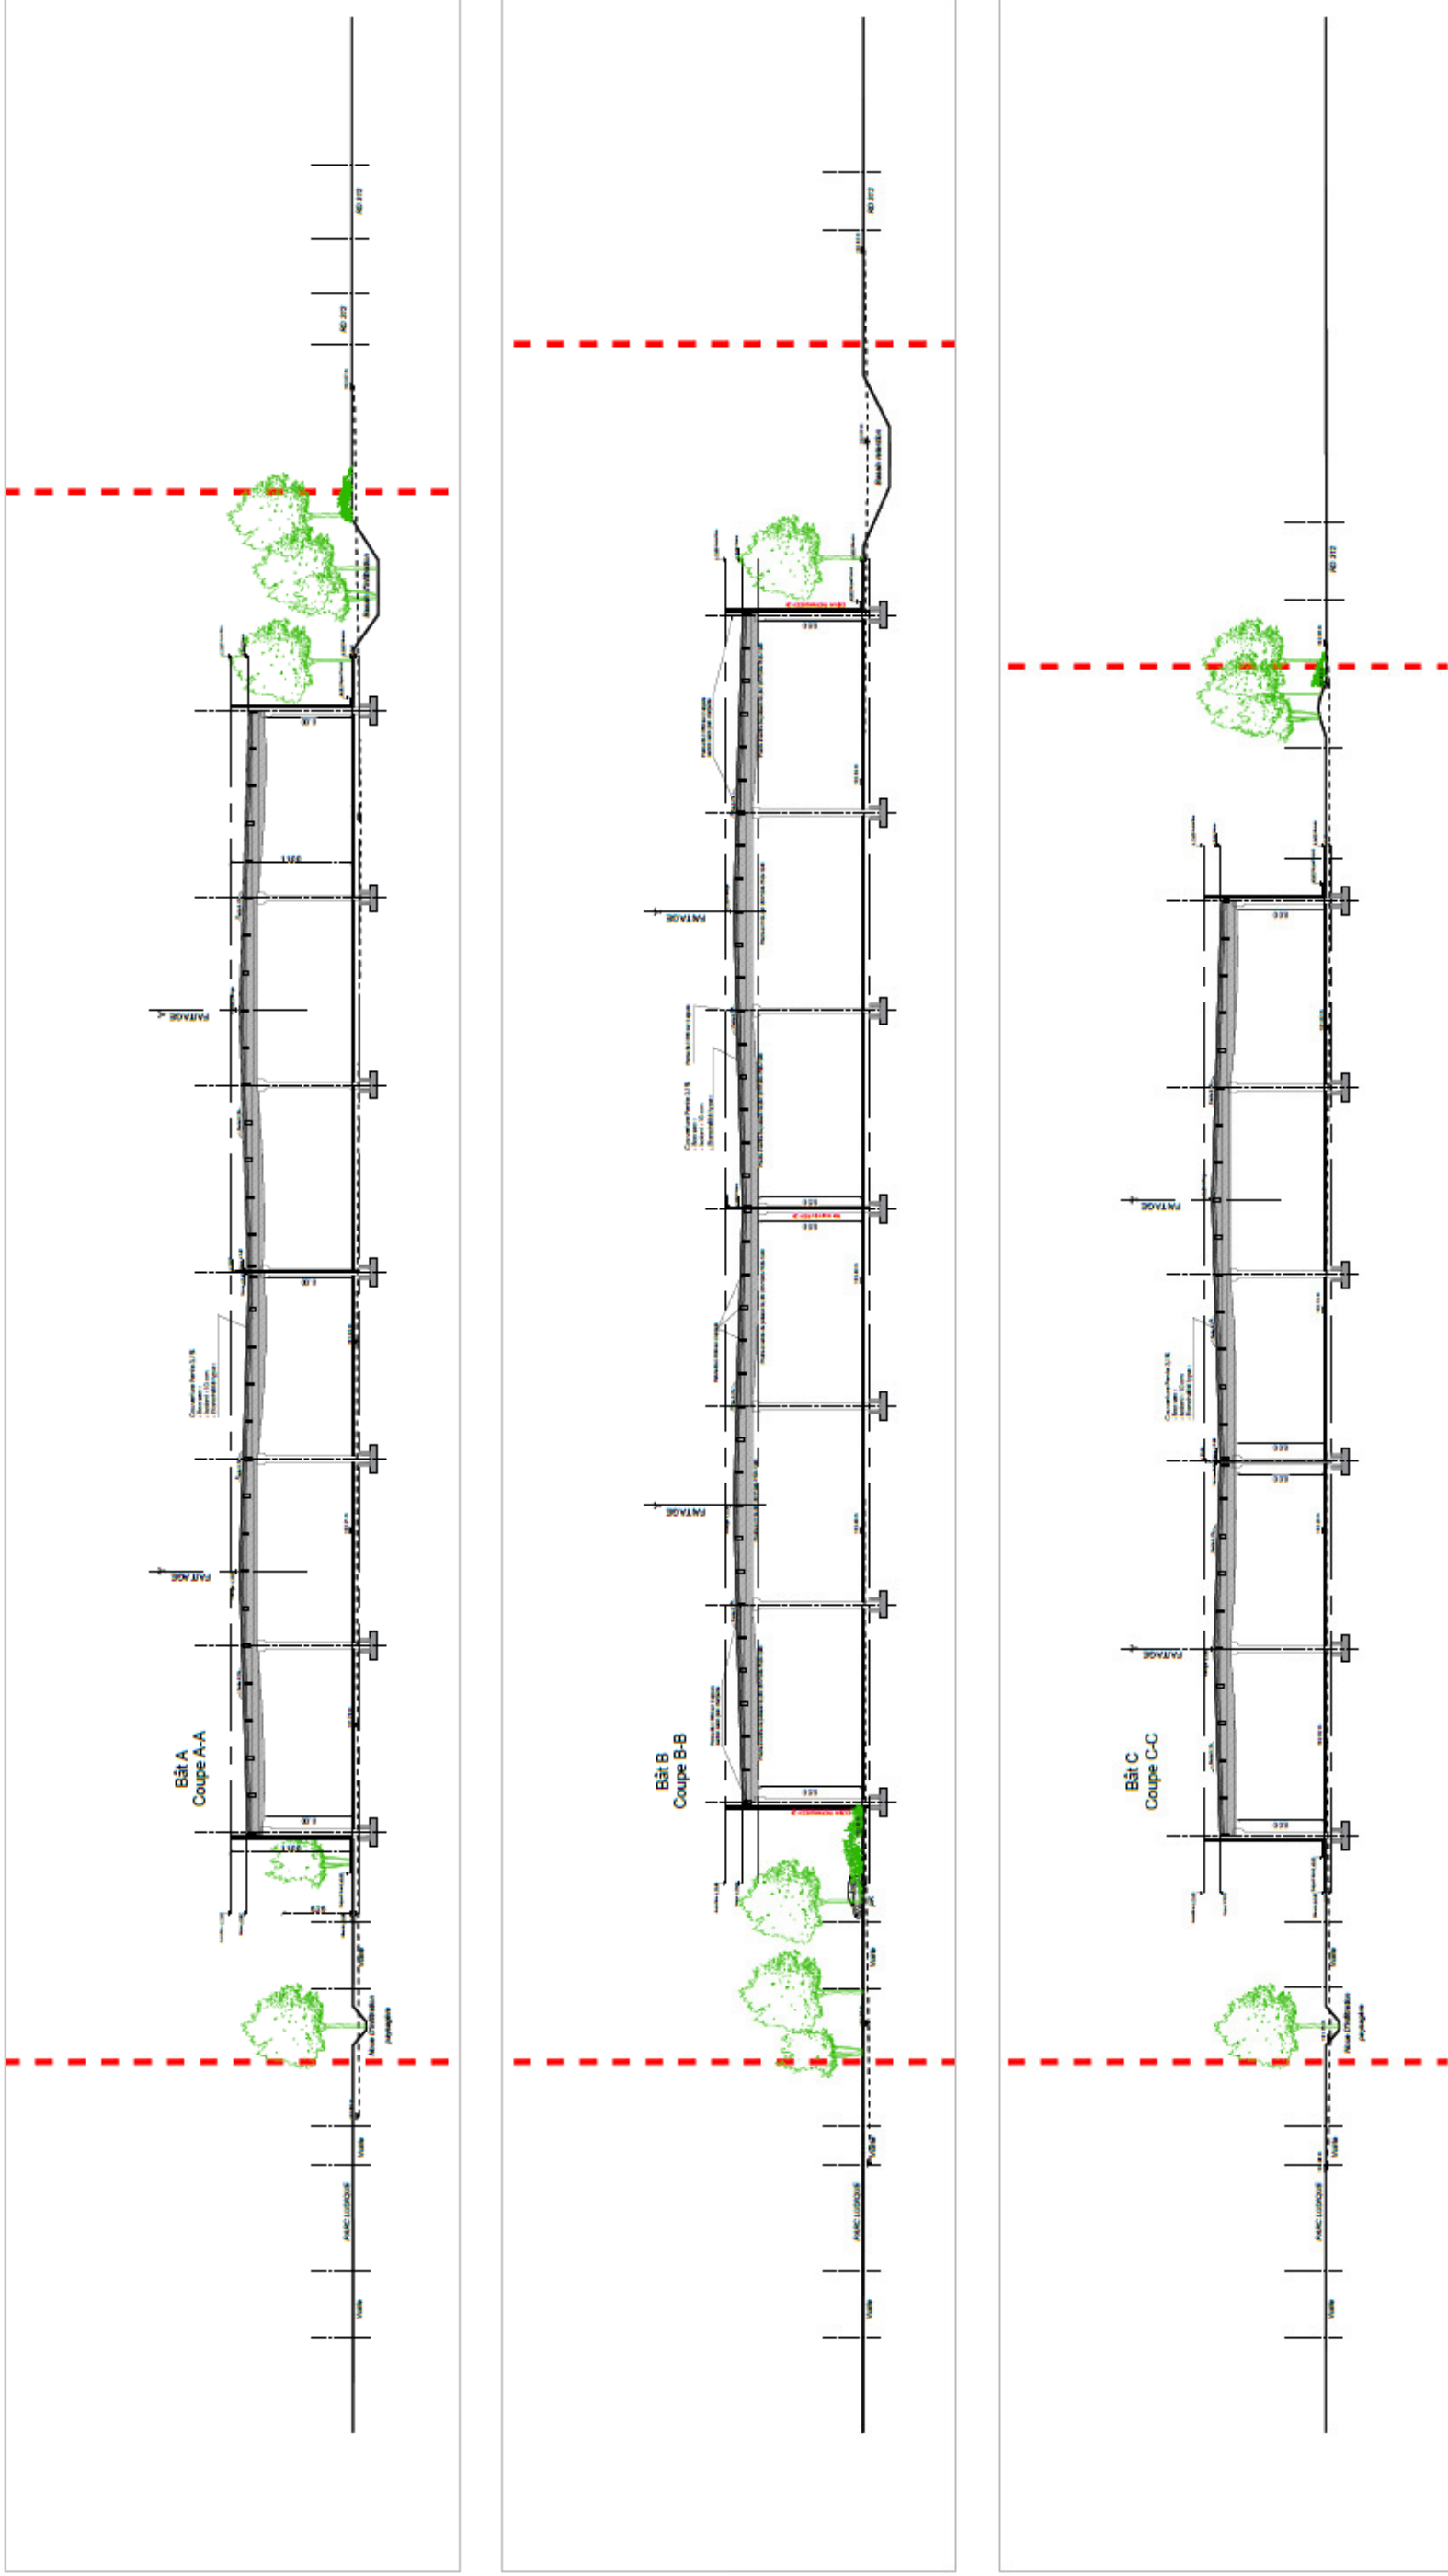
Coupe du projet (source : PC3, EG2A, avril 2024)
